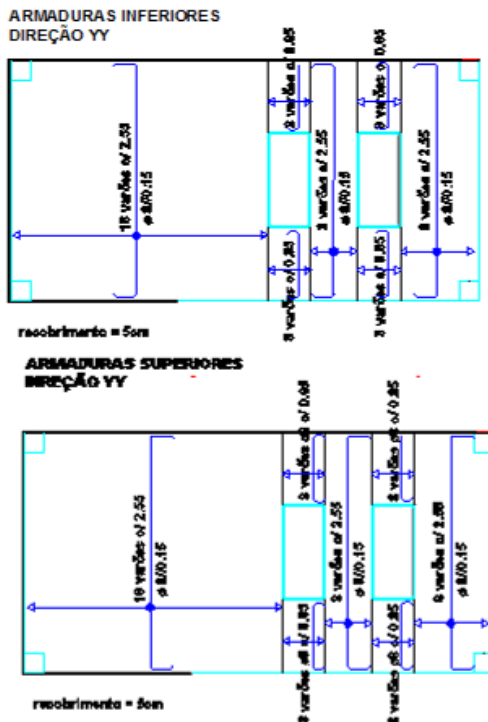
Planta das armaduras da base do edifício do gerador [AVicêncio C, 2017]
